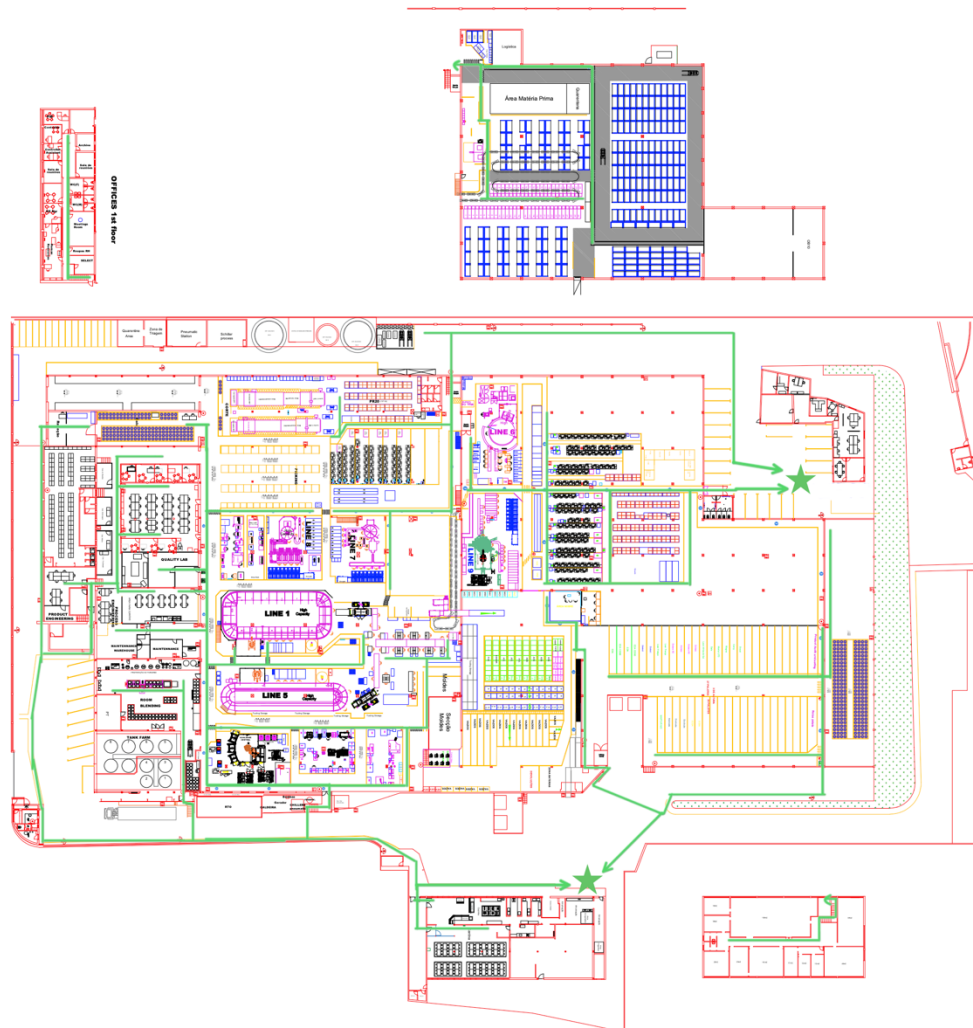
Planta de Emergência (Empresa em estudo, 2025)
